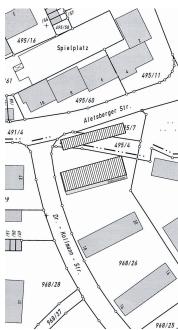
Lageplan M 1:2000, Grafik: Architekturbüro Reiszky
